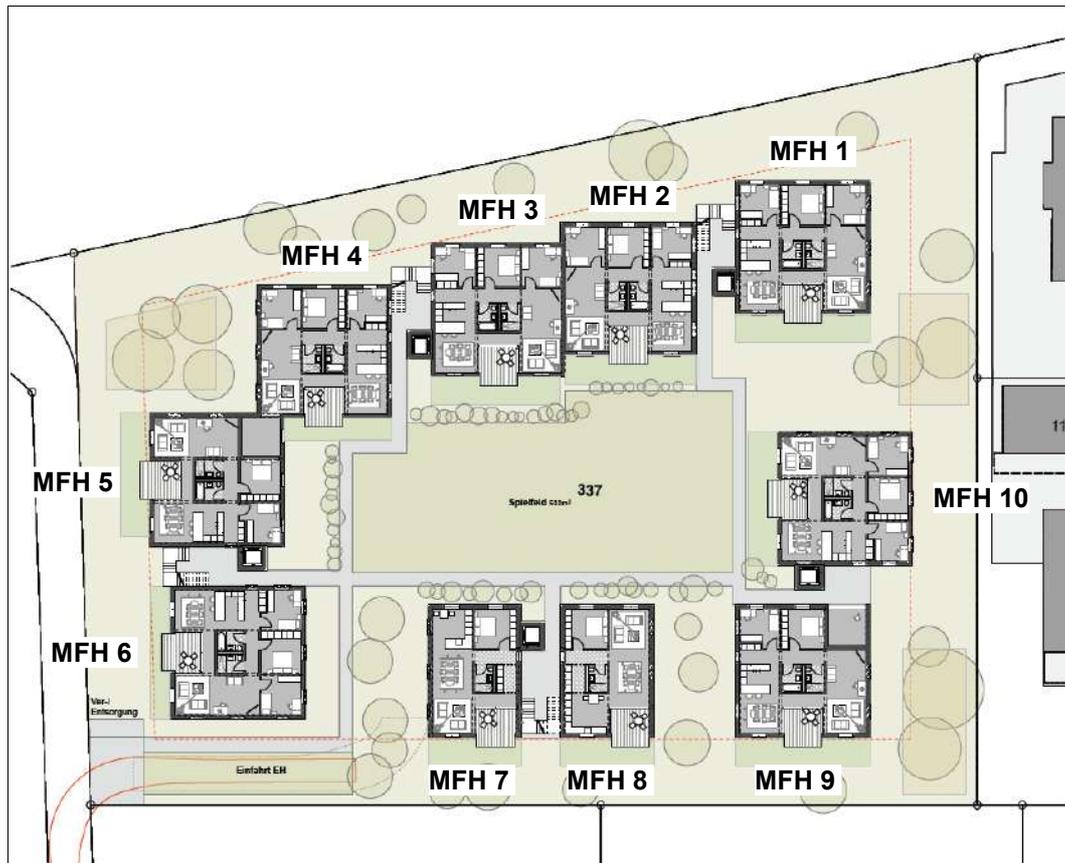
Ausschnitt Situationsplan, ohne Mst.; Quelle: Architekt
